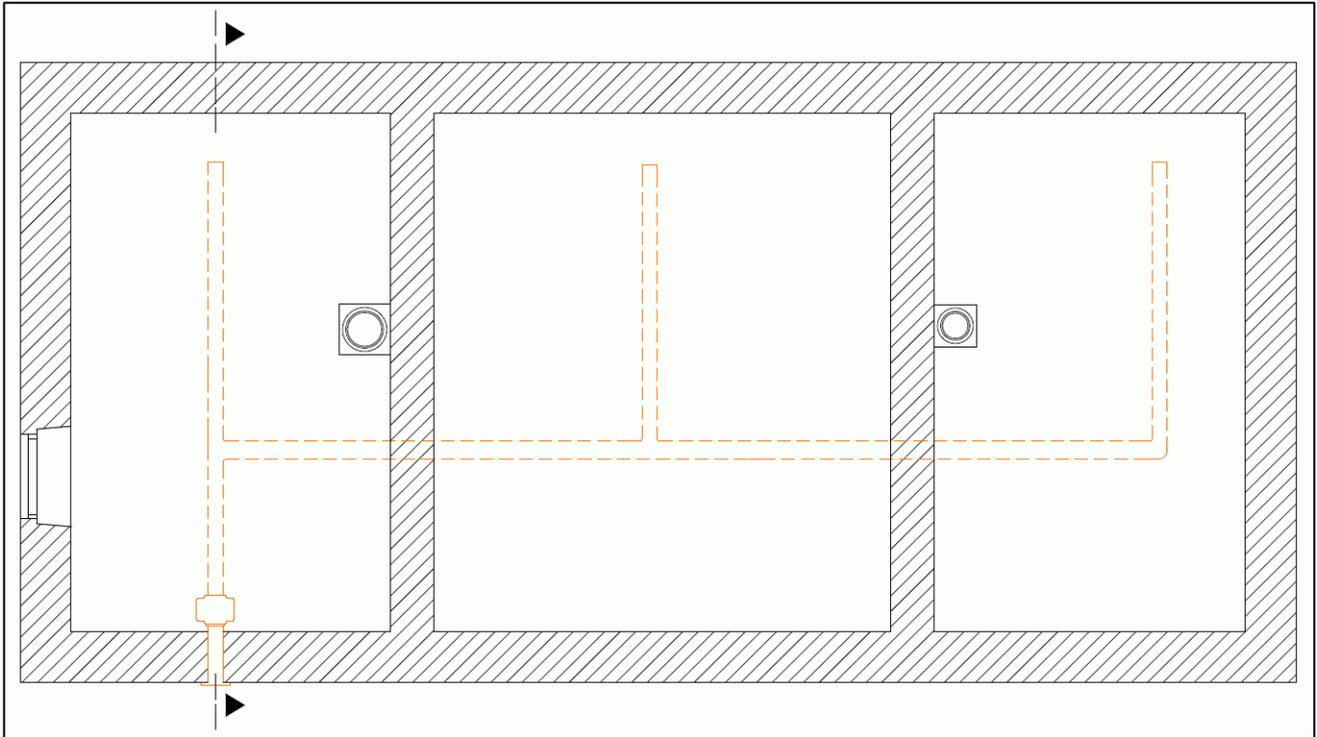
Grundriss, Anordnung Radondrainage
